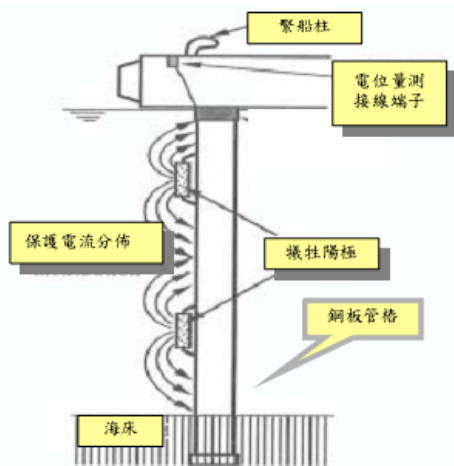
碼頭鋼板(管)樁犧牲陽極法示意圖
